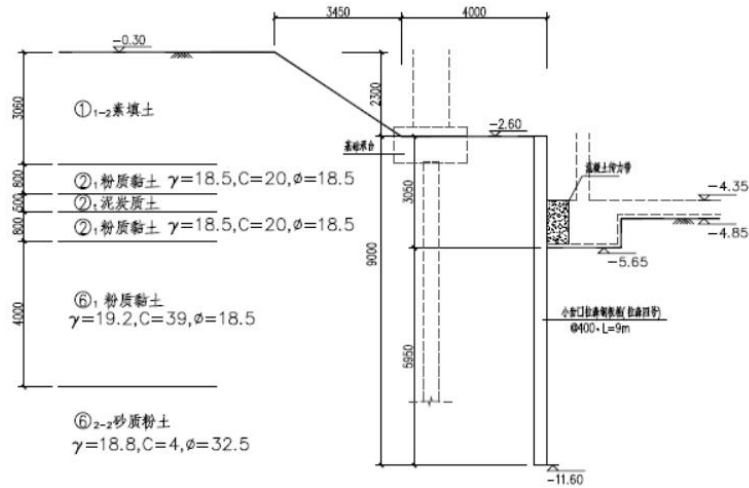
吴江地块基坑开挖竖向布置示意图
